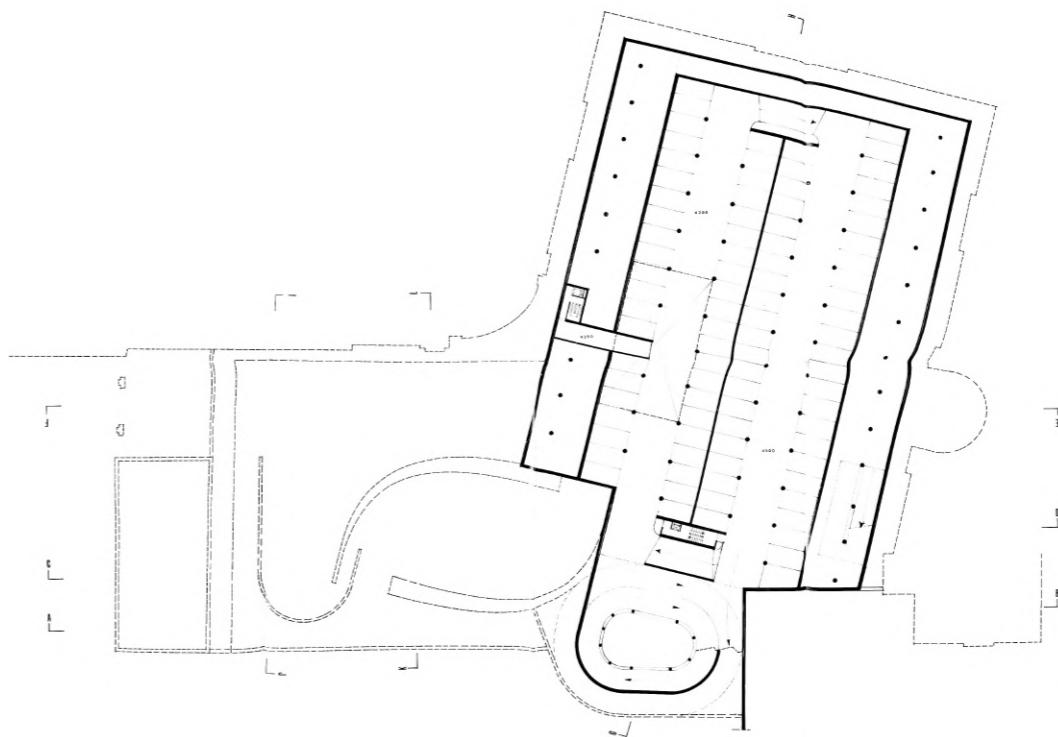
Plan d'un étage de parking, 5^{ème} esquisse v1.
